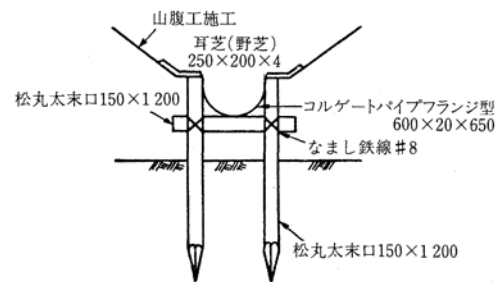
コルゲート水路工の例 (単位 : mm)
